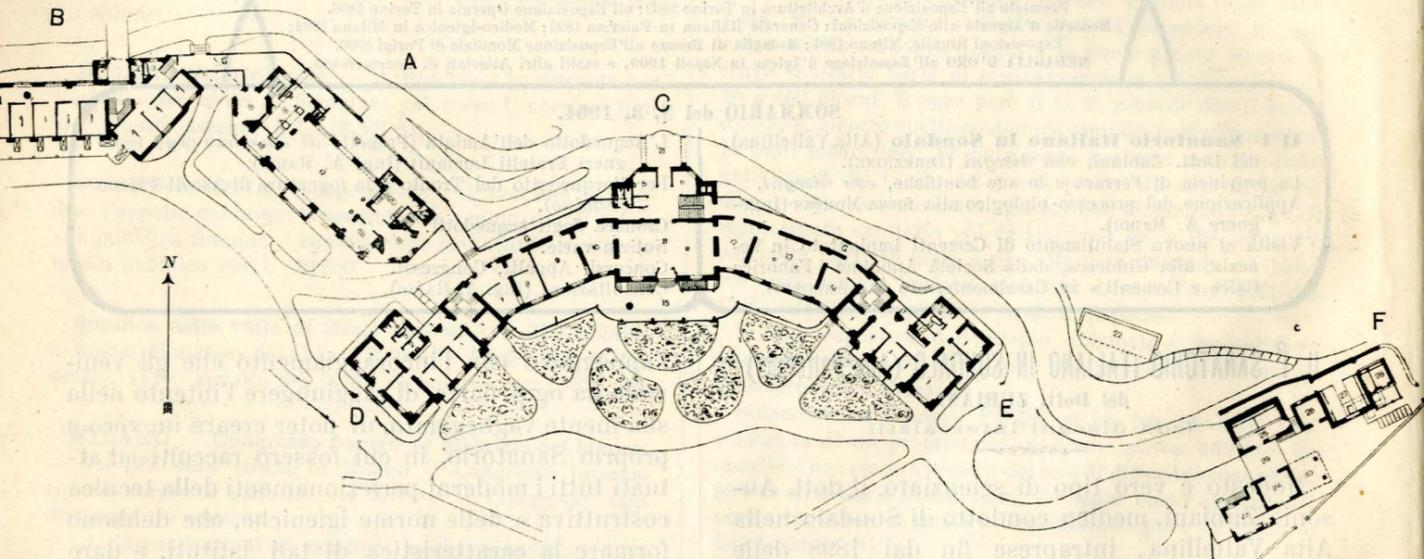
Planimetria generale e pianta del piano terreno (Scala 1:1100).
